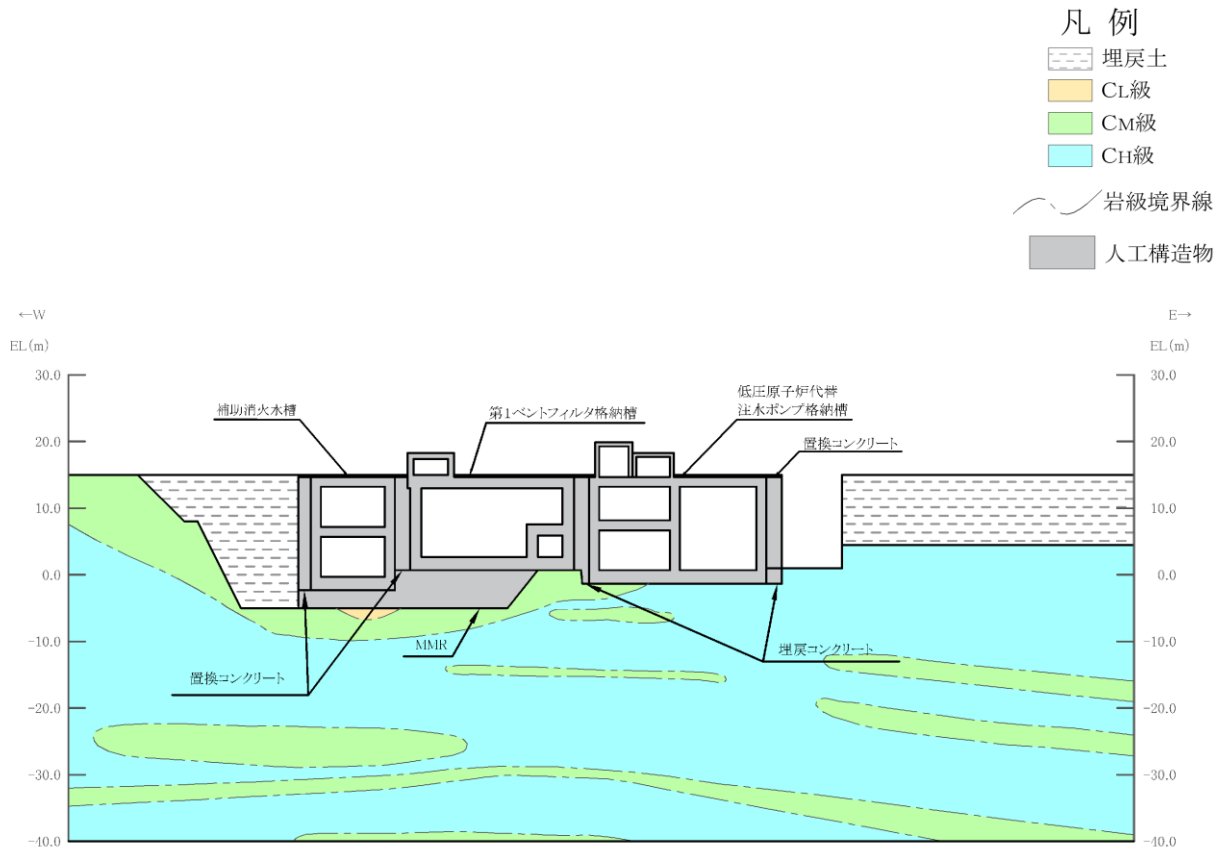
第 1 ベントフィルタ格納槽 評価対象断面図 (C-C 断面位置)
